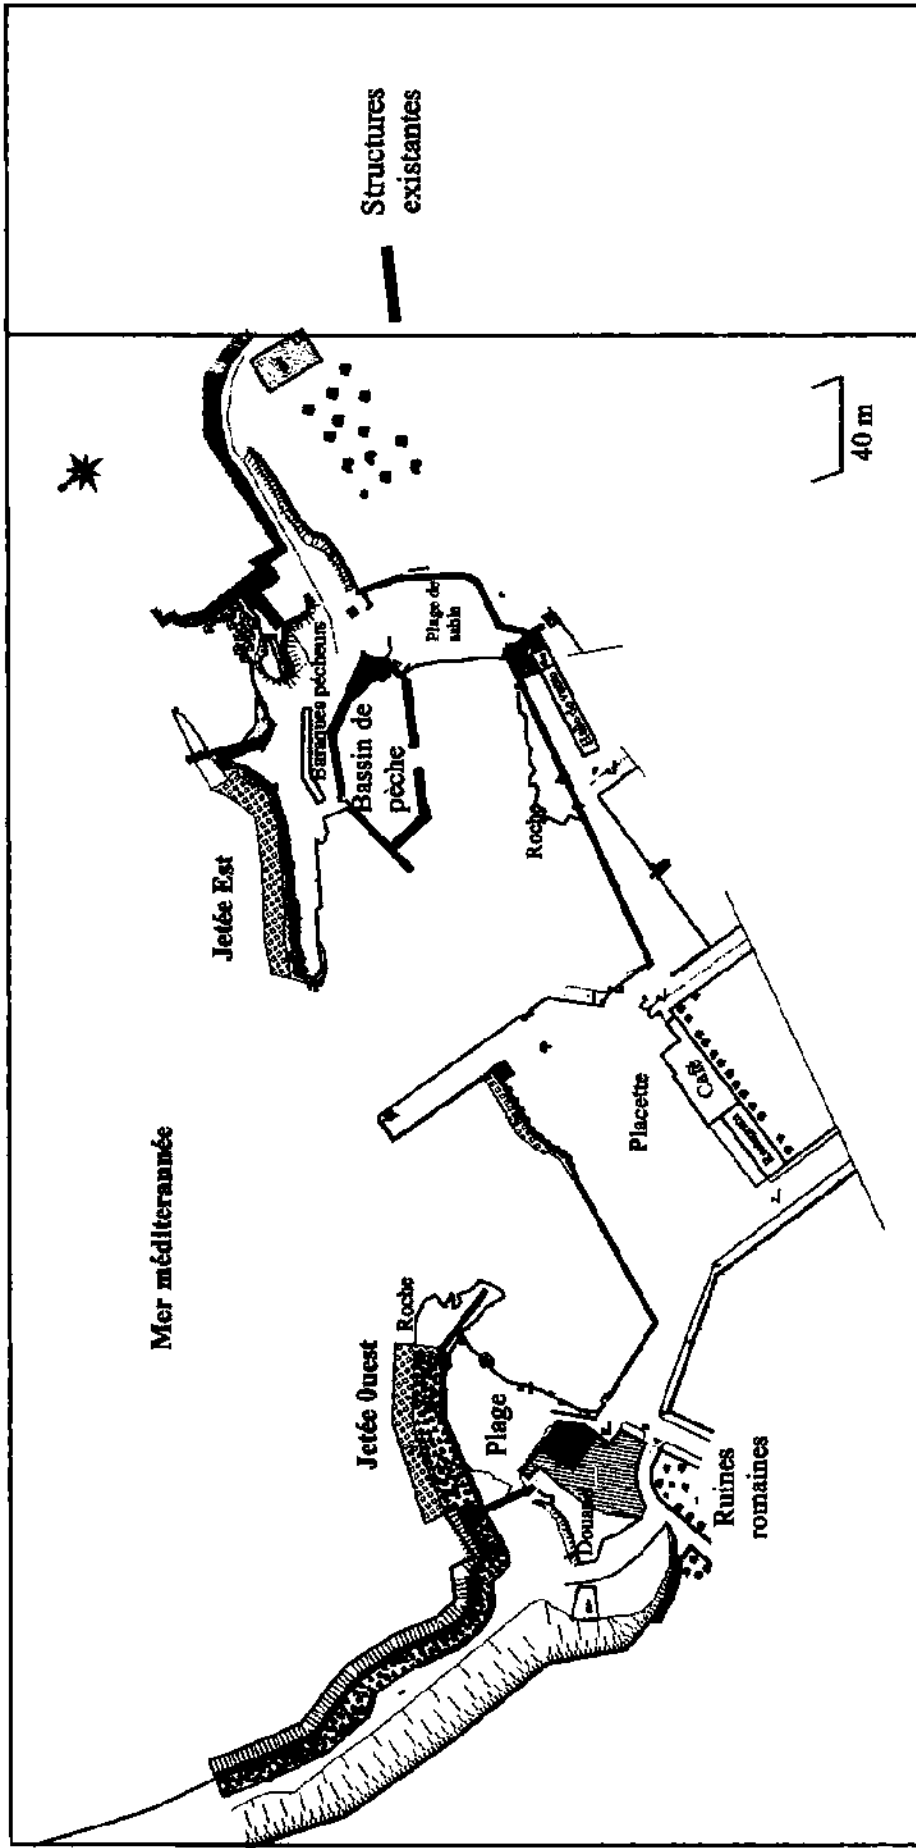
Plan du port de Tipaza avant travaux (2005).
